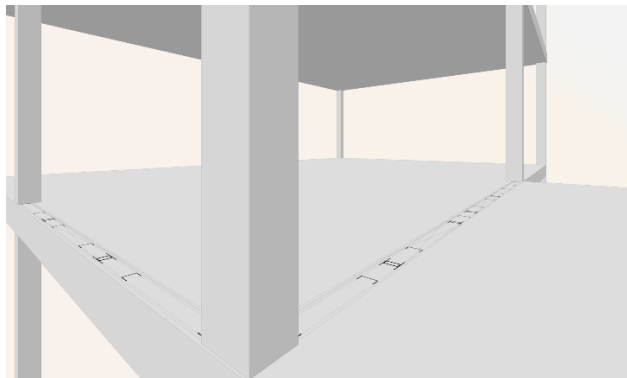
Replanteo del entramado autoportante de fachada ligera.
